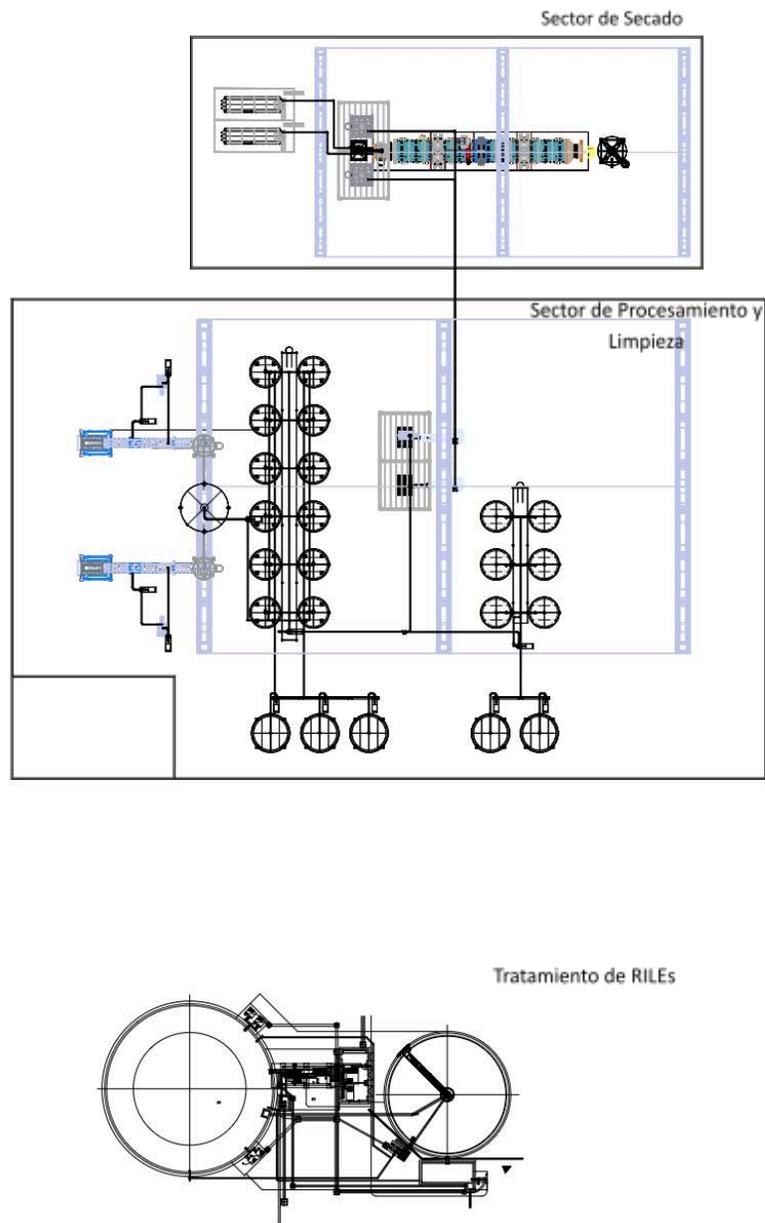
Vista superior de la planta proyectada (Fuente: elaboración propia)
